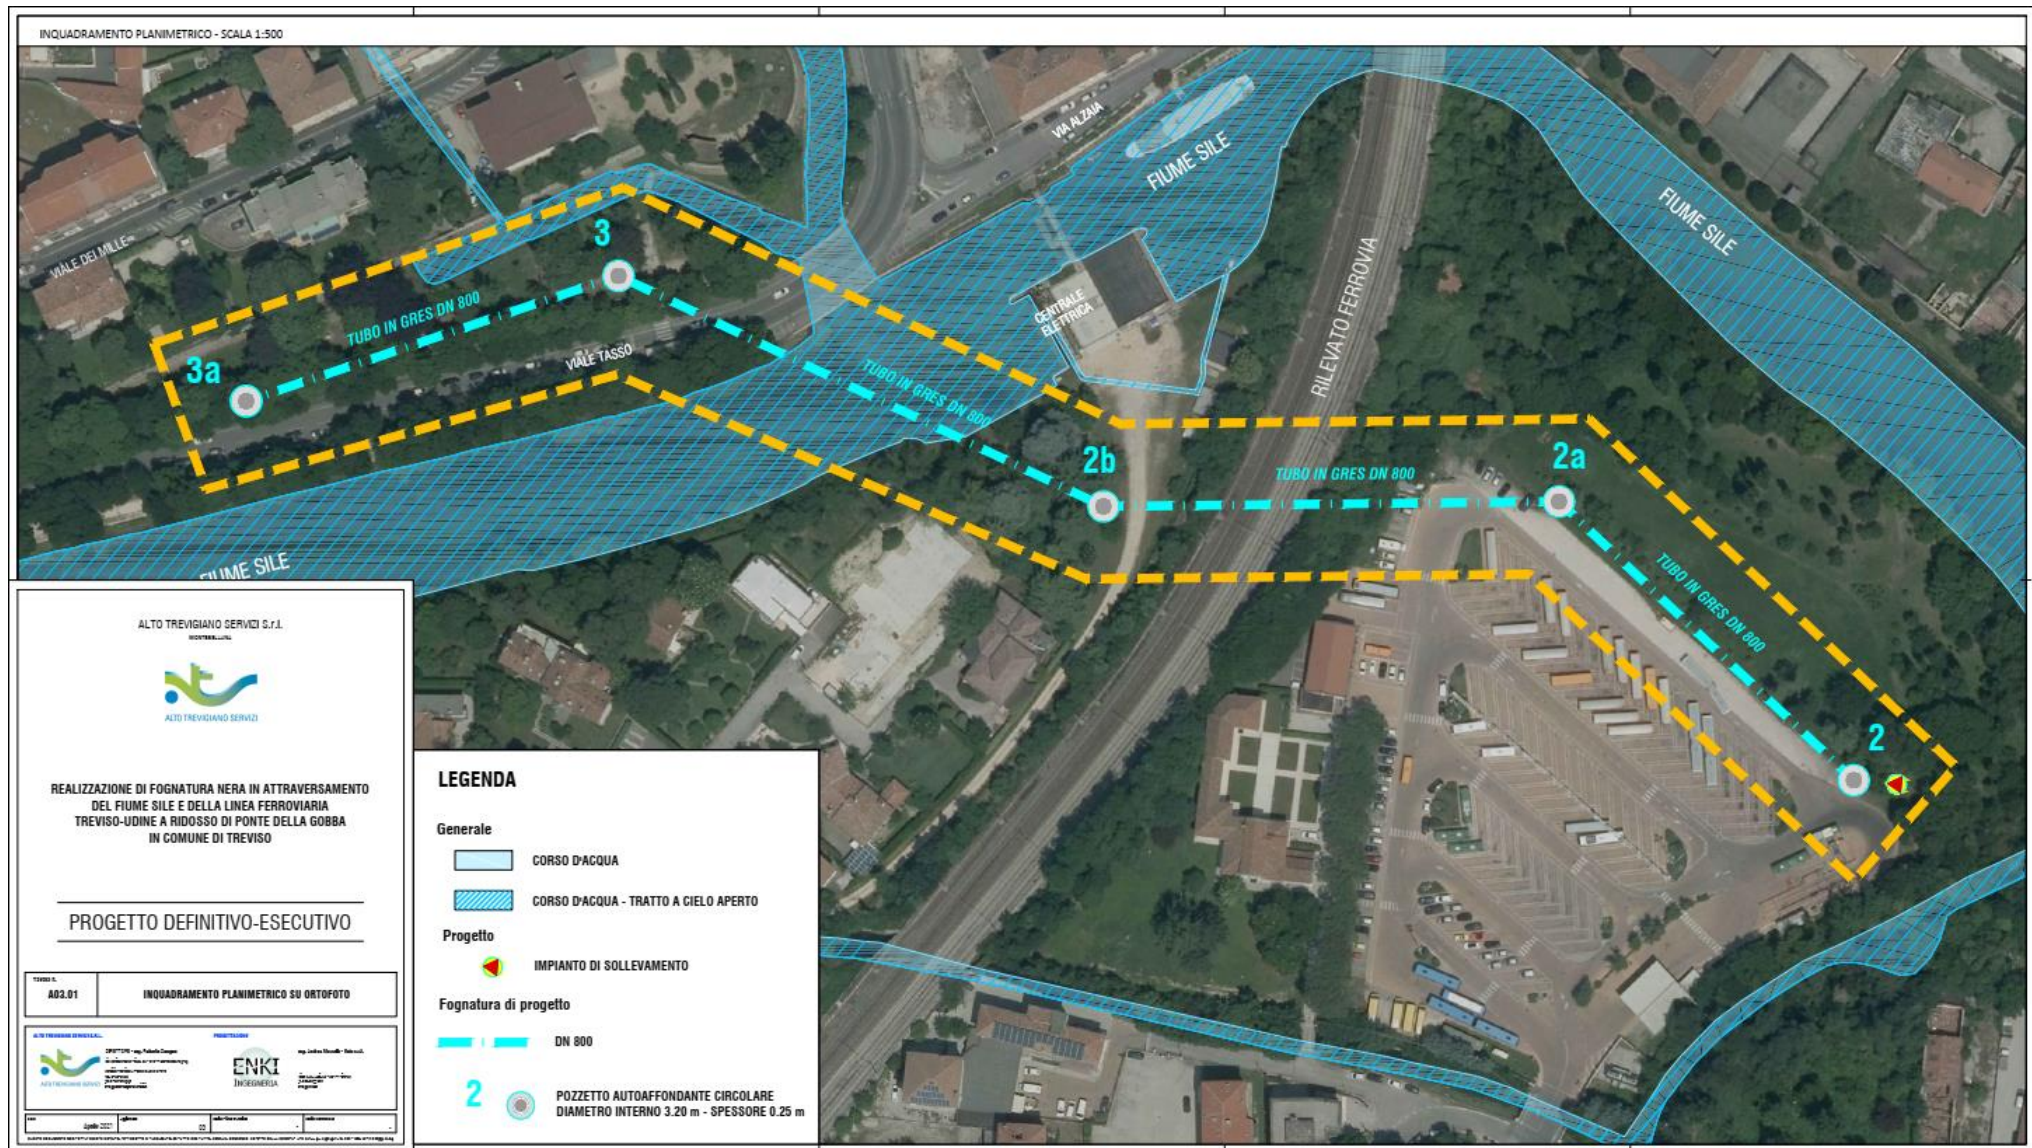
B : Inquadramento planimetrico progetto CONDOTTE FOGNARIE MICROTUNNELLING
